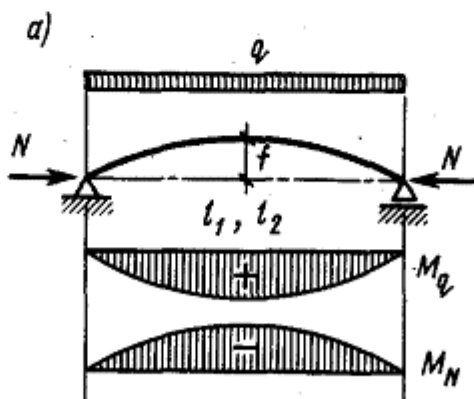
Розрахункові схеми роботи верхніх поясів клеєдерев'яних ферм.
